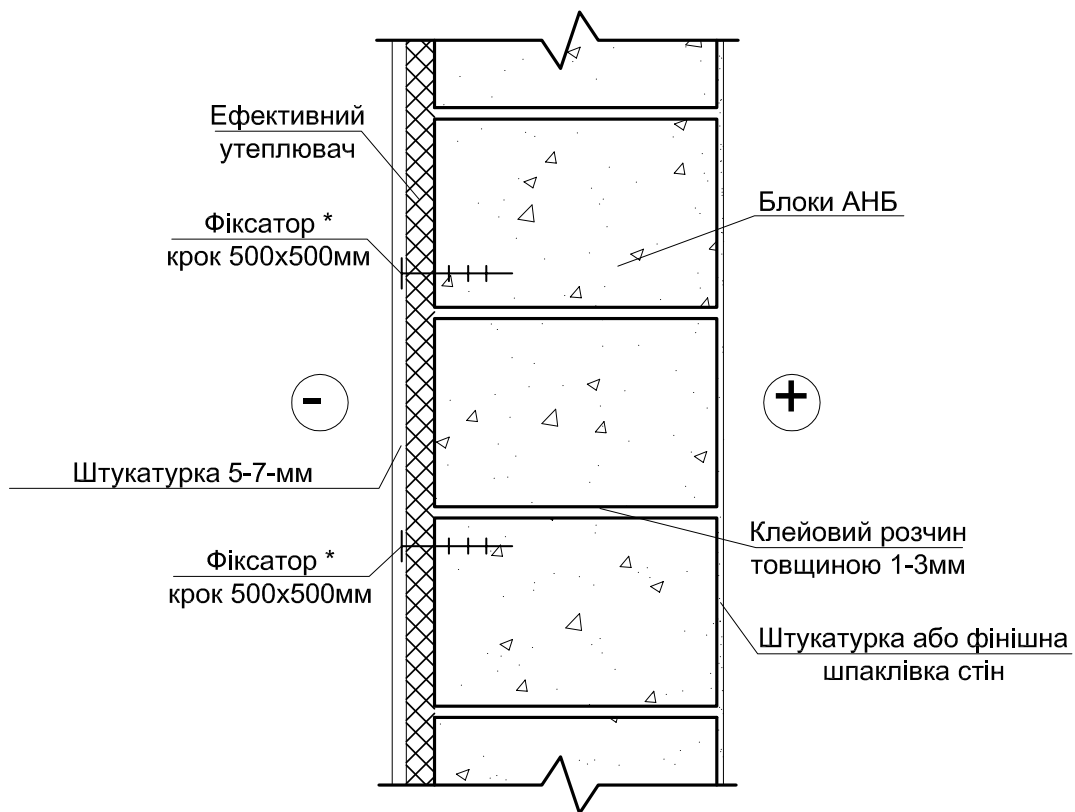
7-11. Багатшарова стіна з опорядженням на основі фасадної системи з утеплювачем та штукатуркою по армосітці
